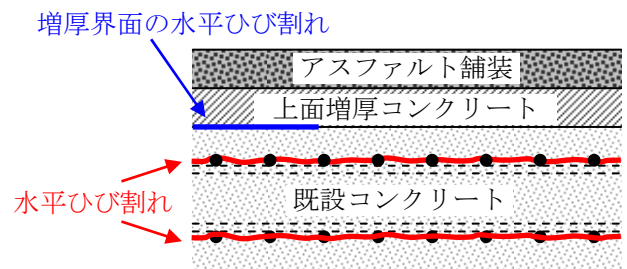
道路橋 RC 床版の水平ひび割れ発生位置
